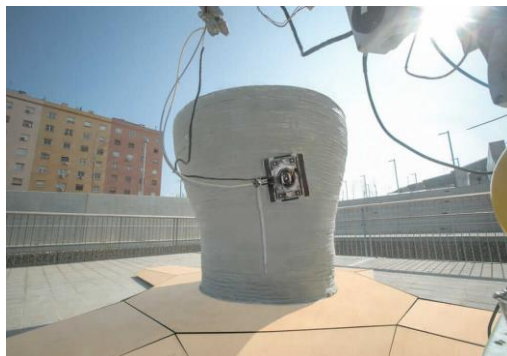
Vacuum Robot* del IAAC. Fuente: <https://www.autodesk.com/redshift/drone-3d-printer/>
